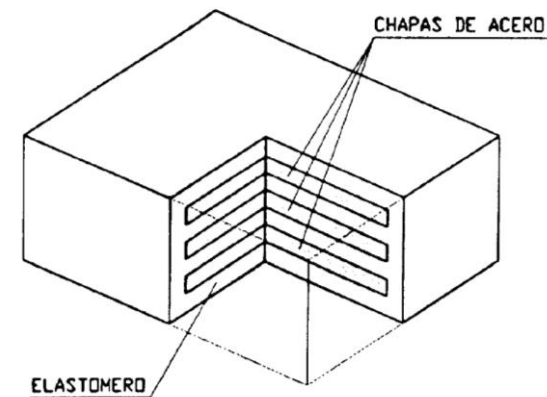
Aparato de apoyo de neopreno zunchado. (Fuente: Nota técnica sobre aparatos de apoyo para puentes de carretera, 1995).
